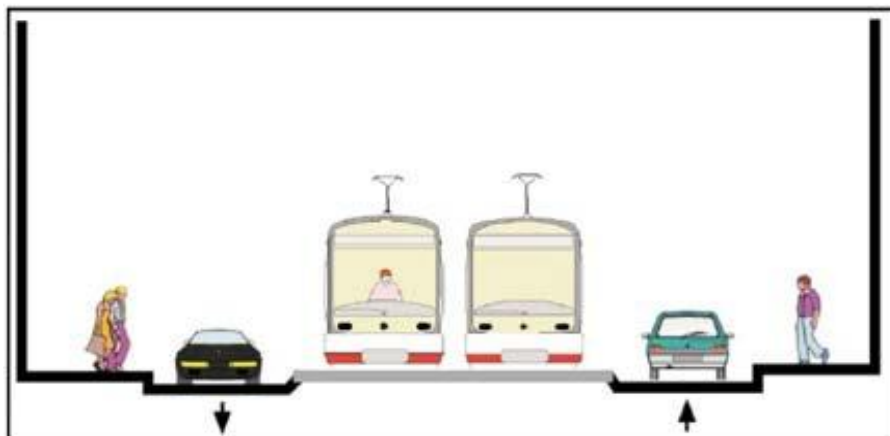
L'implantation axiale d'une plateforme de tramway [57]
